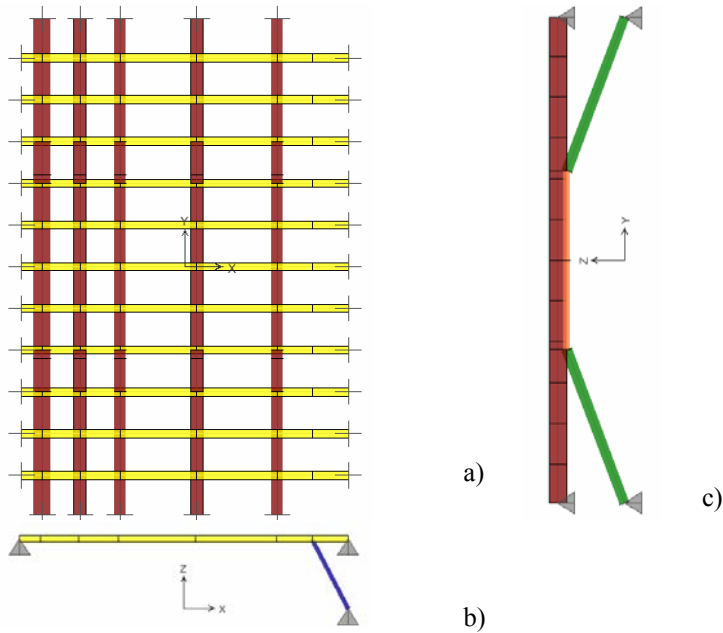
Modello strutturale del solaio: a) Pianta; b) Sezione xz; c) Sezione yz.
